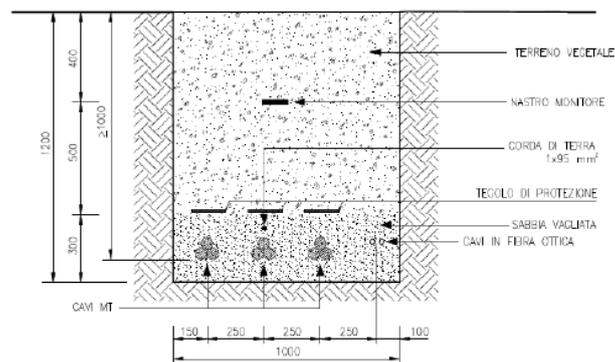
Sezione di posa cavidotti su terreno vegetale
